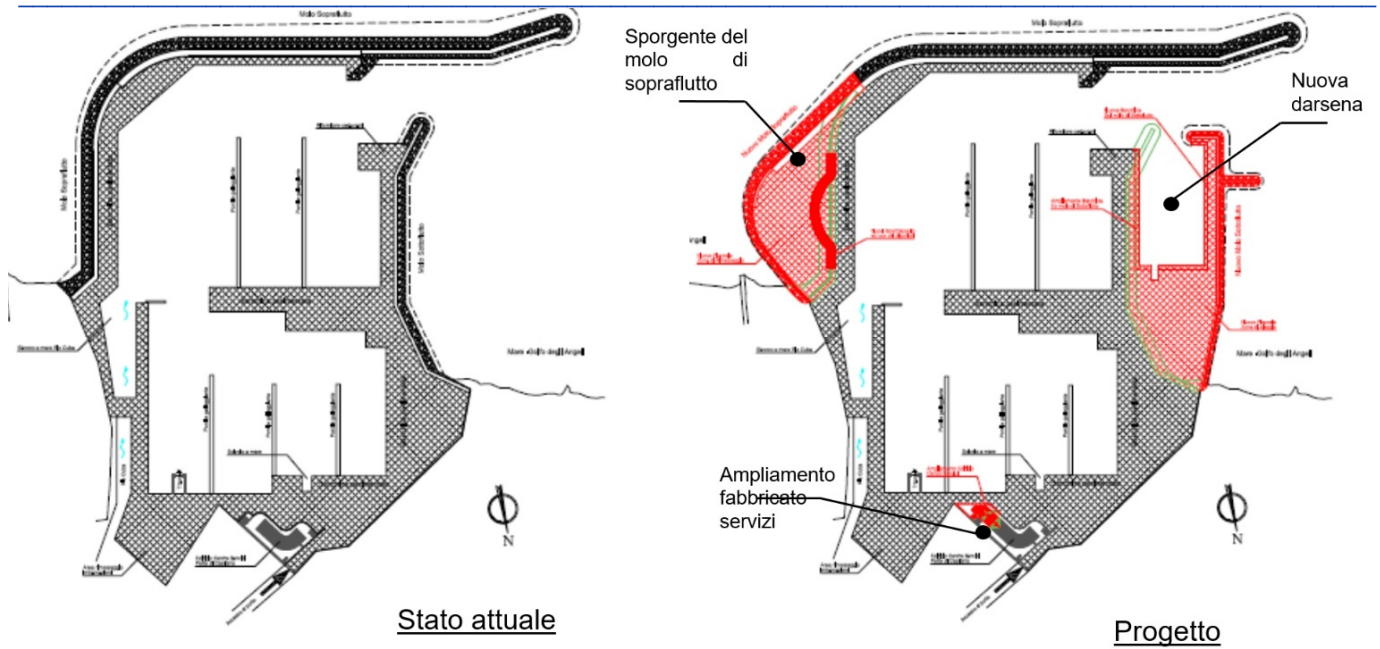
Confronto dell'assetto planimetrico del porto (stato attuale e progetto)
